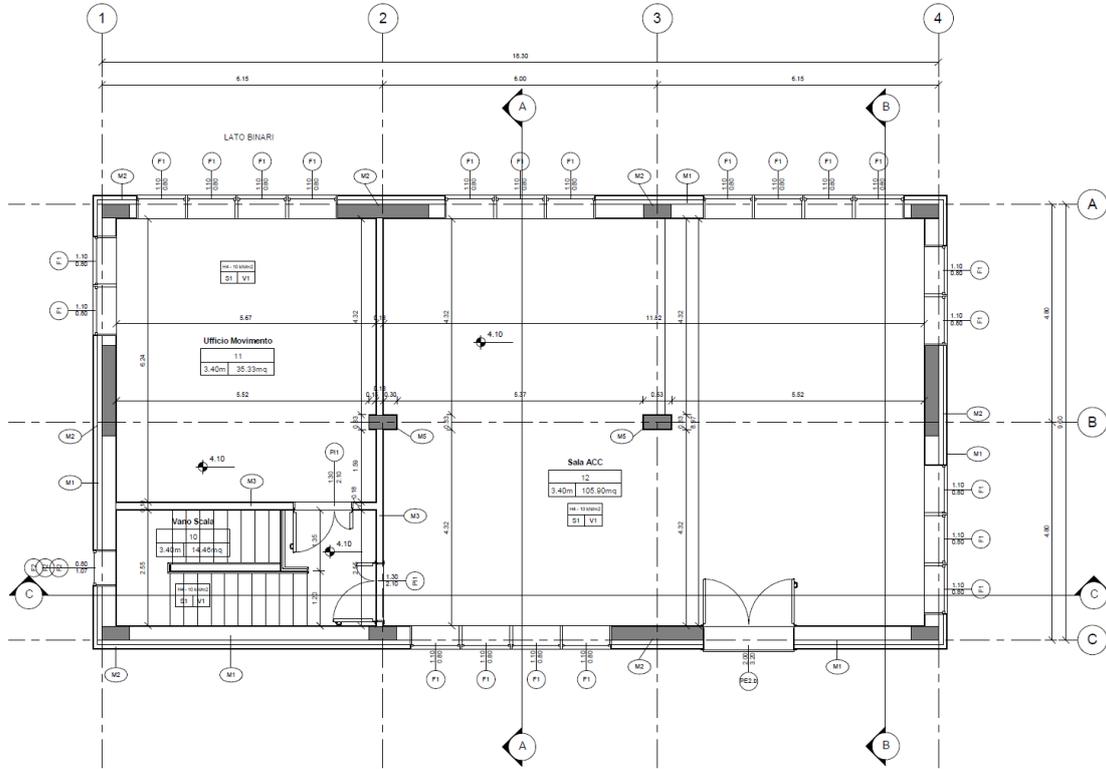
FA01 - Fabbricato ACC Pianta Piano Primo
